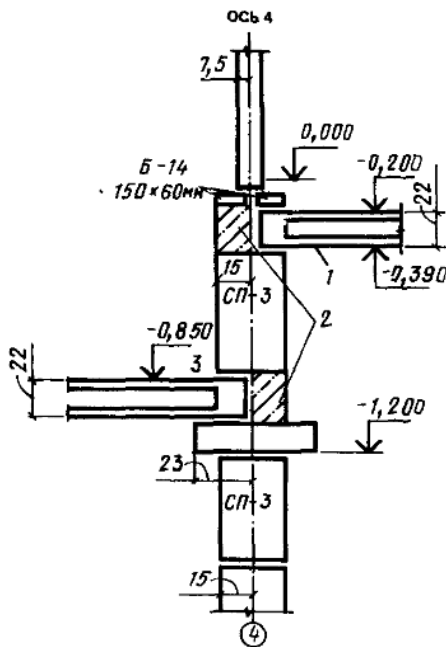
Схема узла по переносу плит перекрытия подвала:
